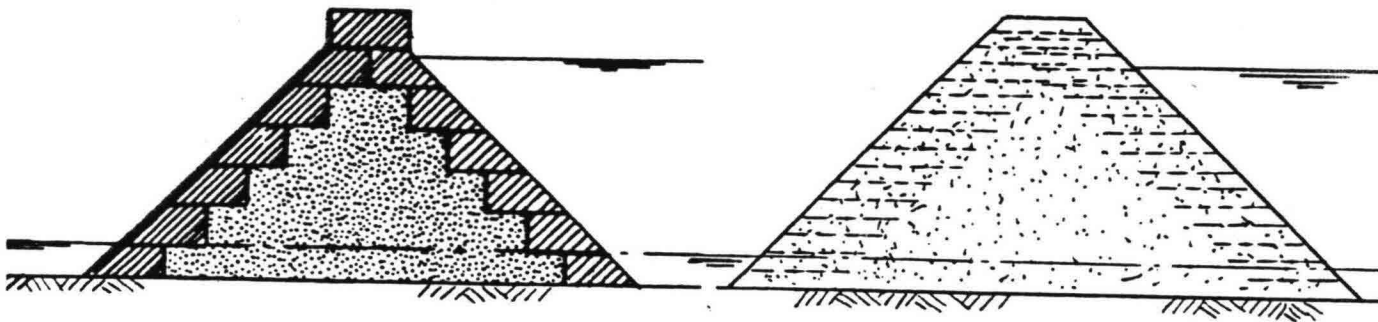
Alternatieve waterkeringen, bild 1
